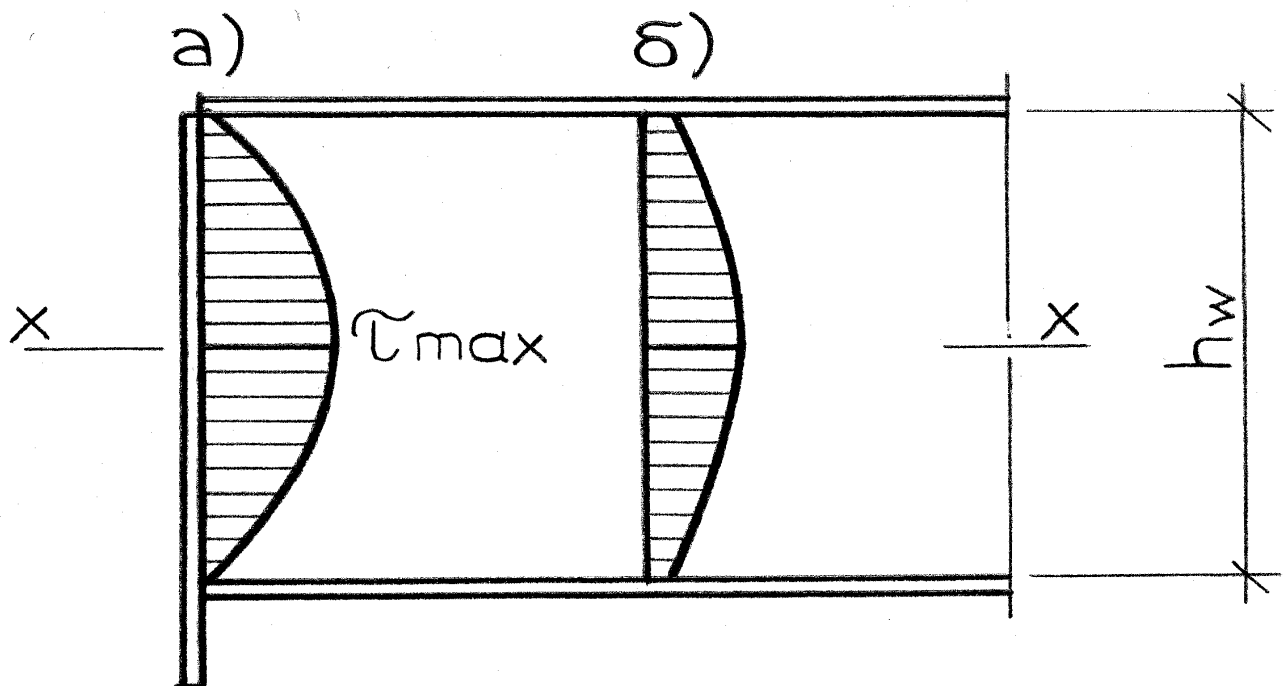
Эпюры касательных напряжений в стенке на опоре и в пролете балки. а – на опоре; б – в пролете
